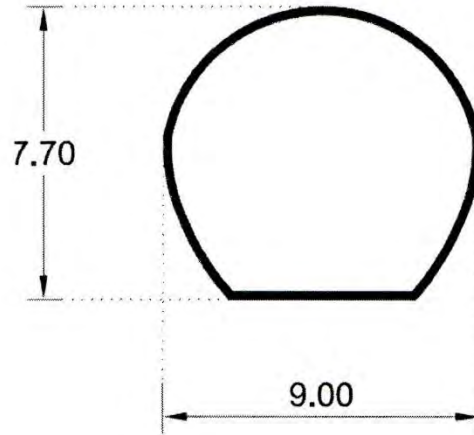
Sección transversal del Túnel de Conexión.
